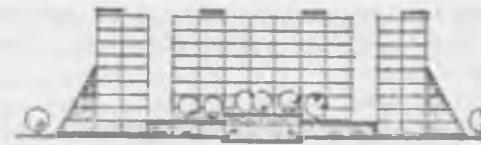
Изображение по рядовым ярусам зданий, соответствующих бетонным конструкциям к жесткой жилой застройке
